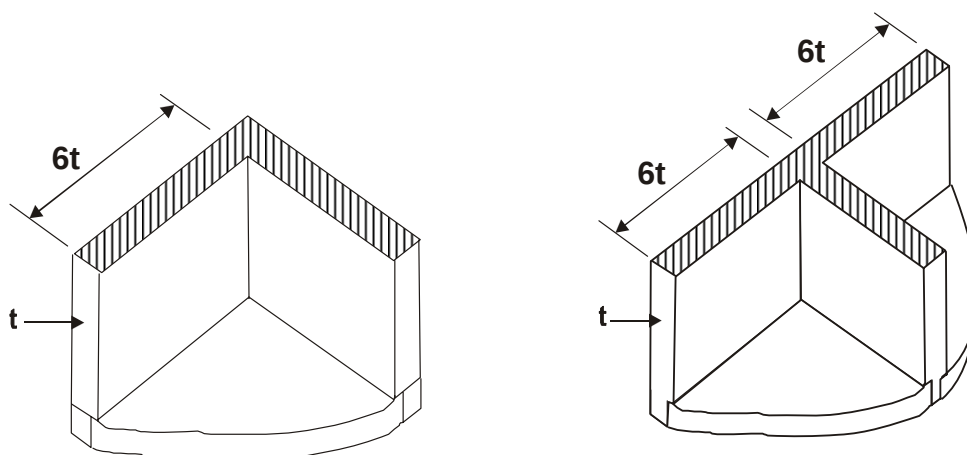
Ancho efectivo de las alas de muros de mampostería
